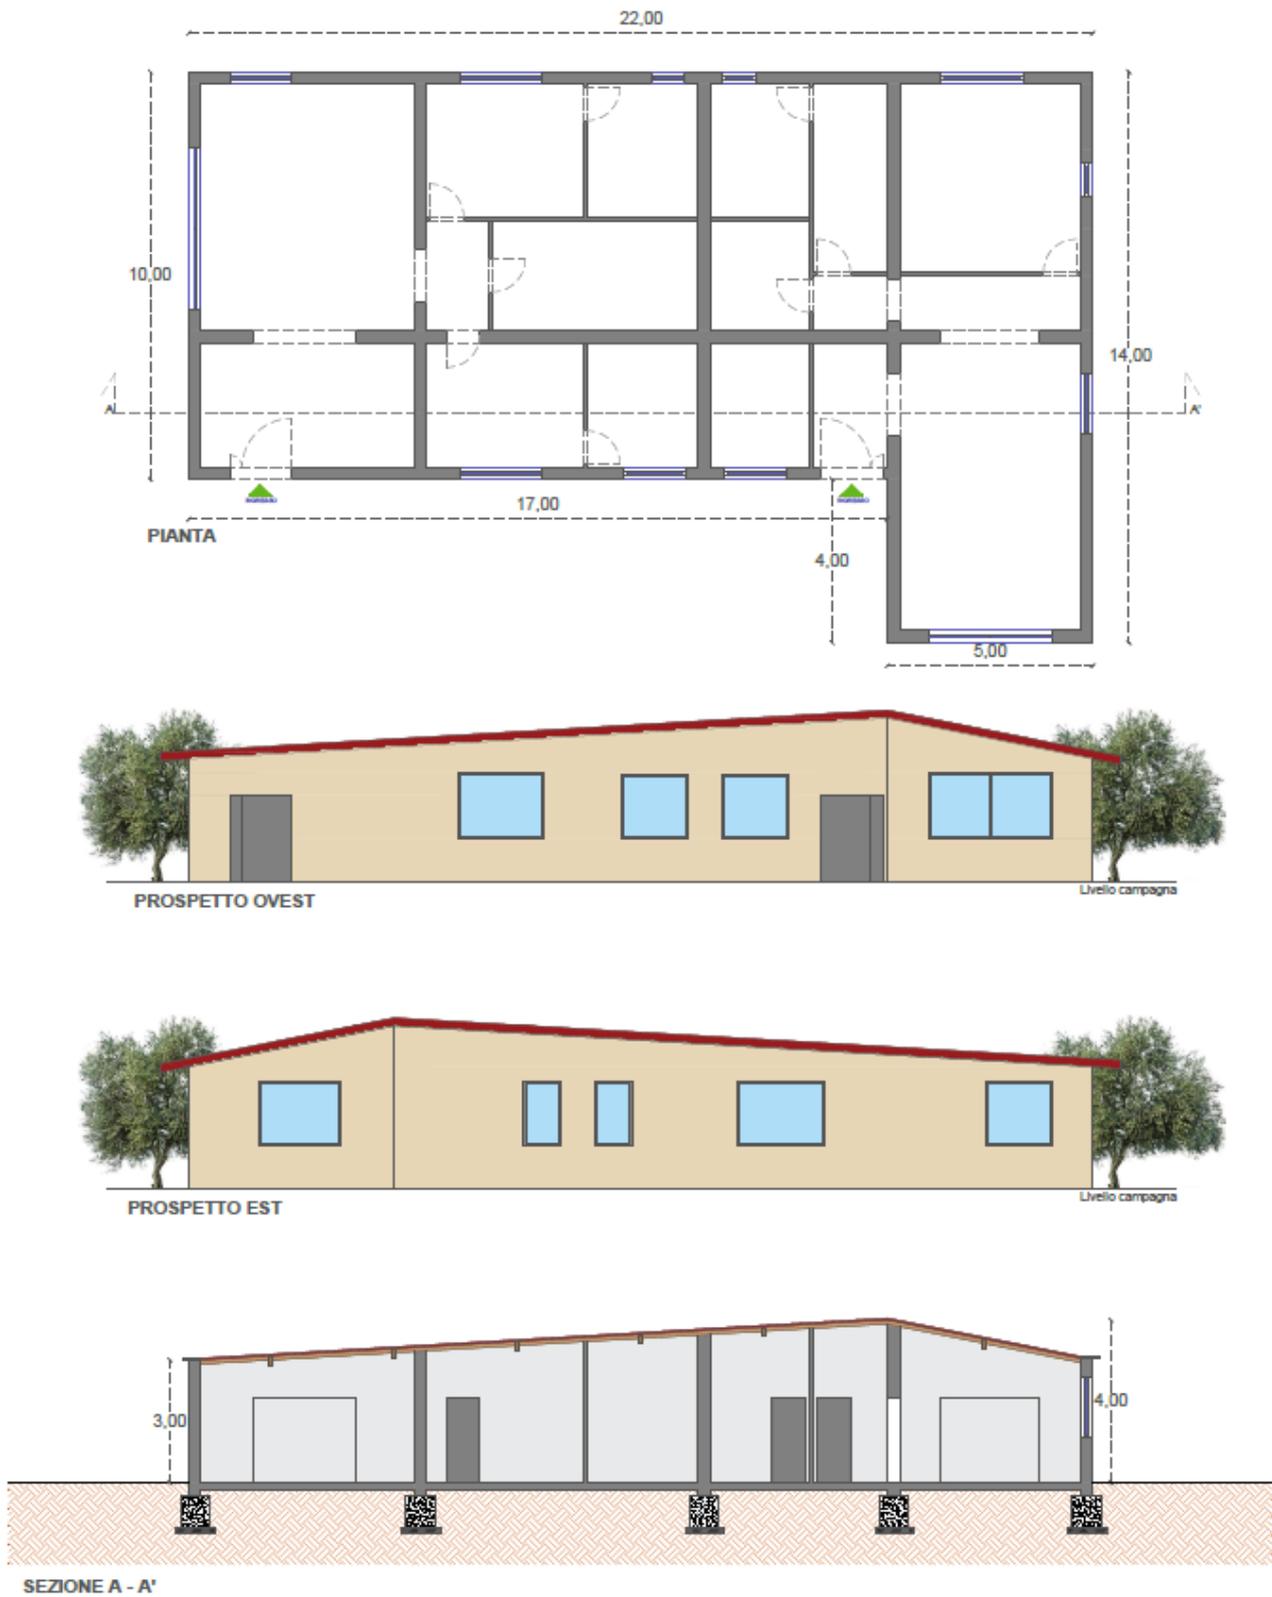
Pianta, Prospetti e Sezione del fabbricato rurale agricolo n°2
